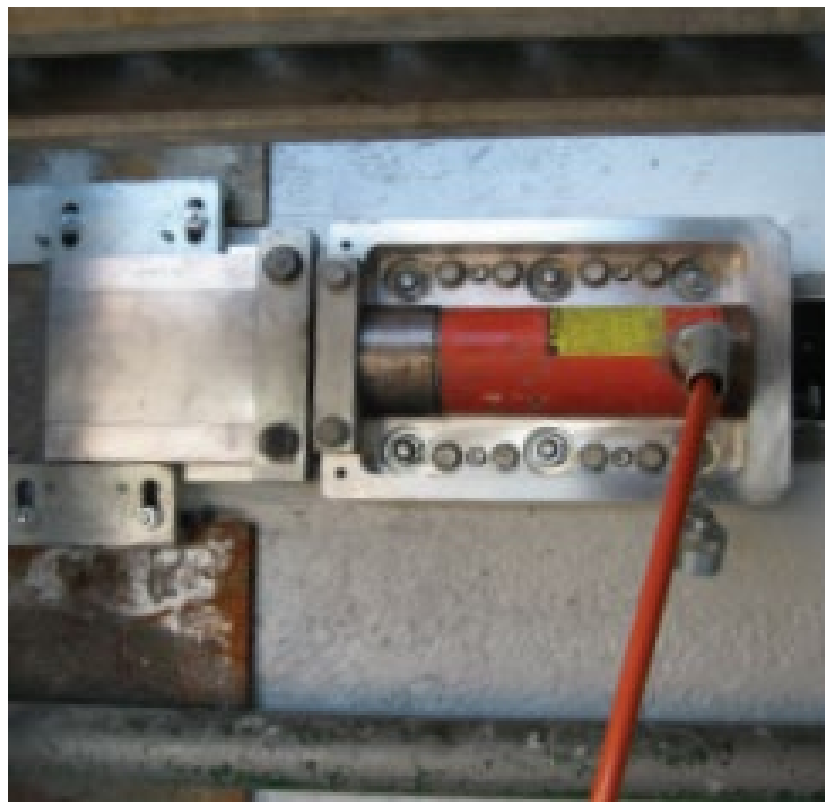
Exemplo de elemento de CFRP laminado com sistema de pré-esforço (Catálogo S&P C-Laminate)
